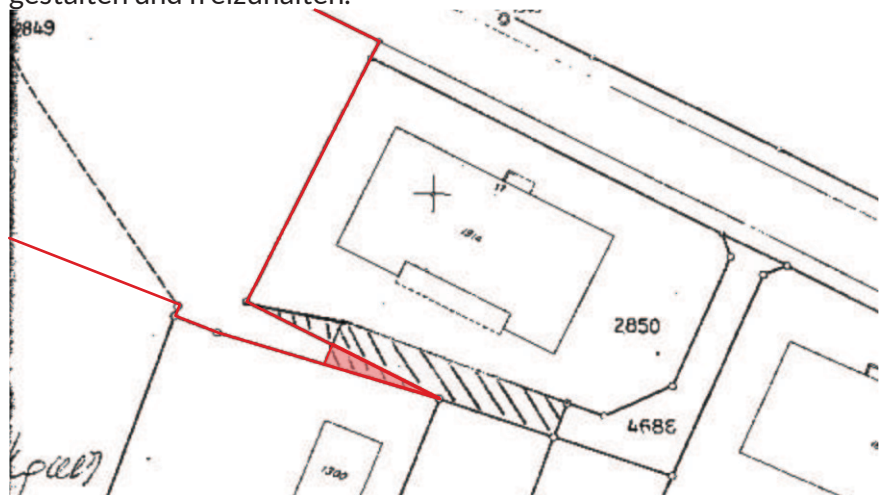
Planbeilage Grundbuch, rot = innerhalb GP-Perimeter
